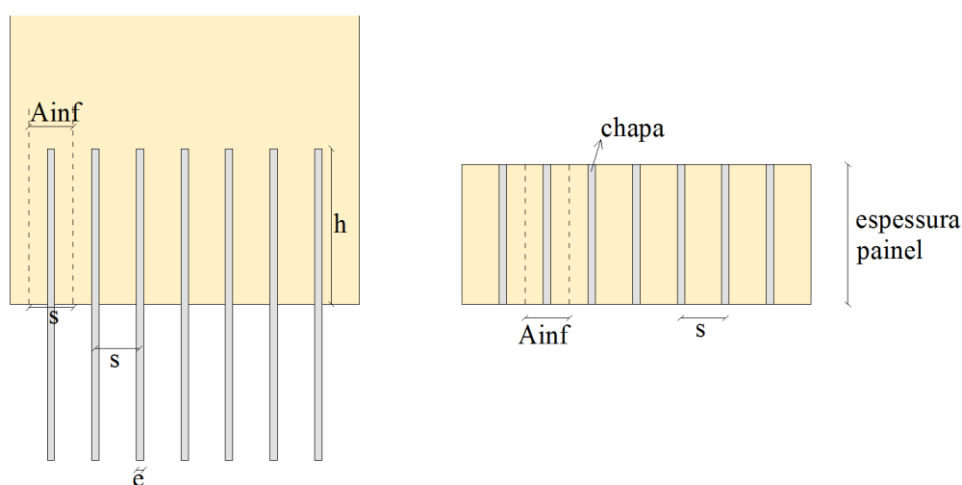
Ligação com chapas de aço: a) Alçado; b) Vista Superior.
